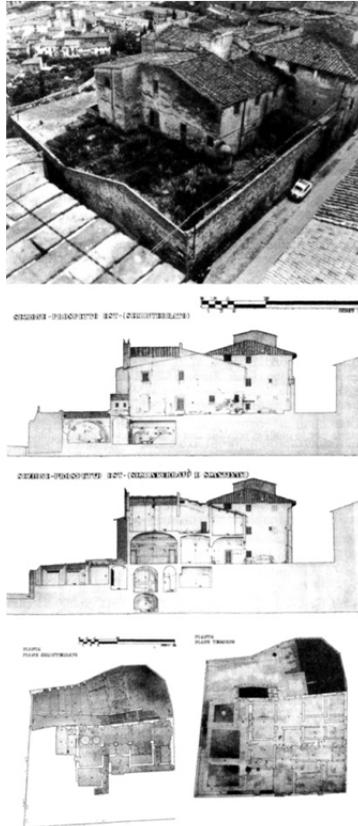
Sezioni, prospetti e piante dei progetti pilota
